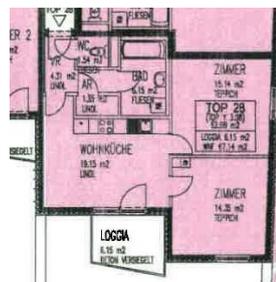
3-Zimmer-Wohnung Bauteil Nord
